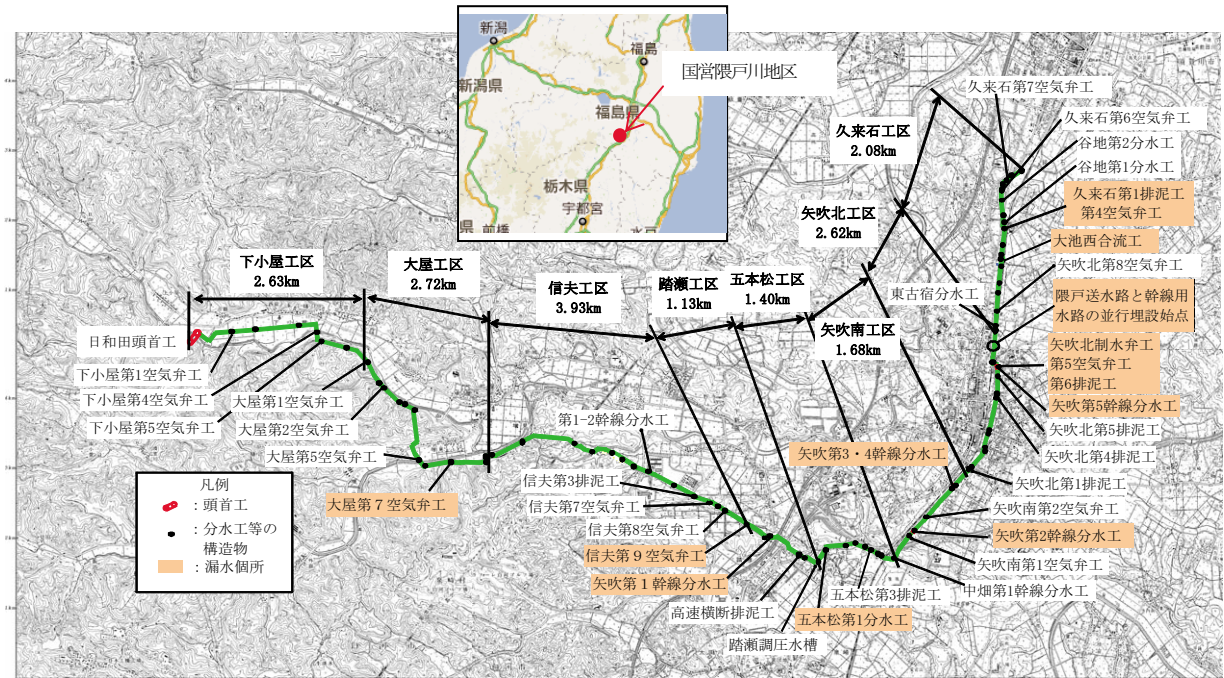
国営隈戸川地区の幹線パイプライン平面図
